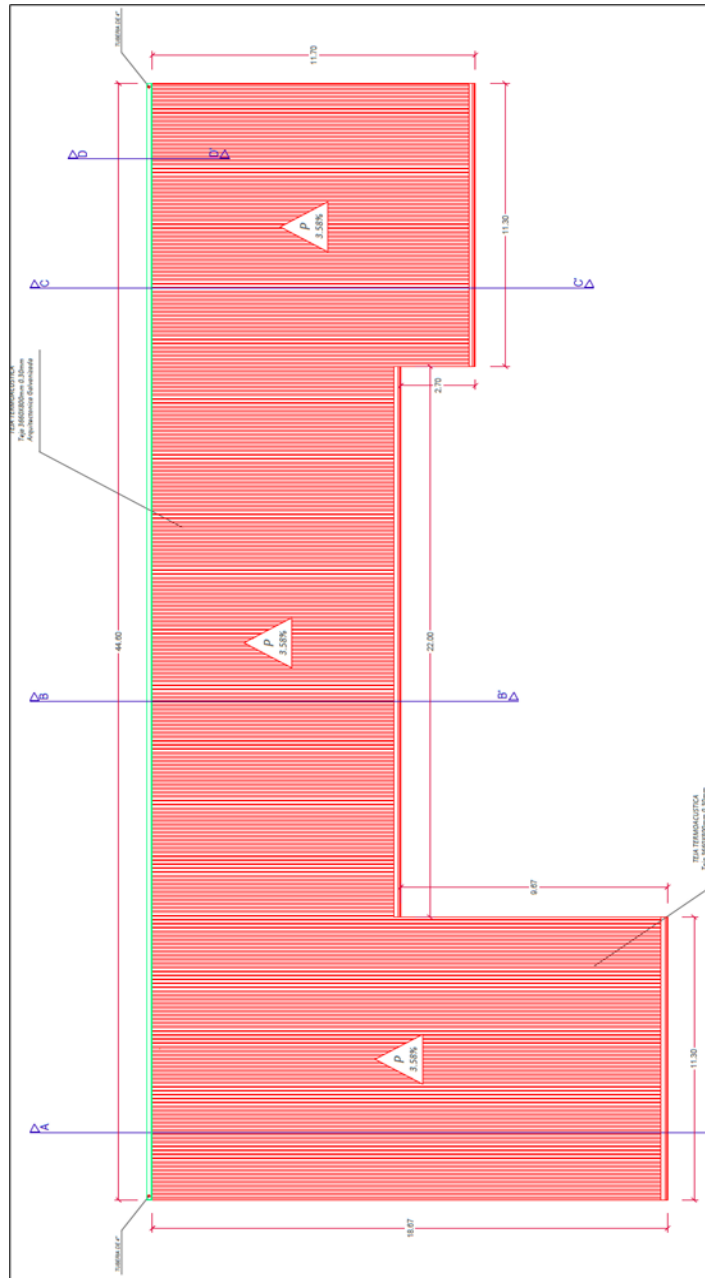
Vista en planta de techo de la estructura 2 del Centro Vida.
